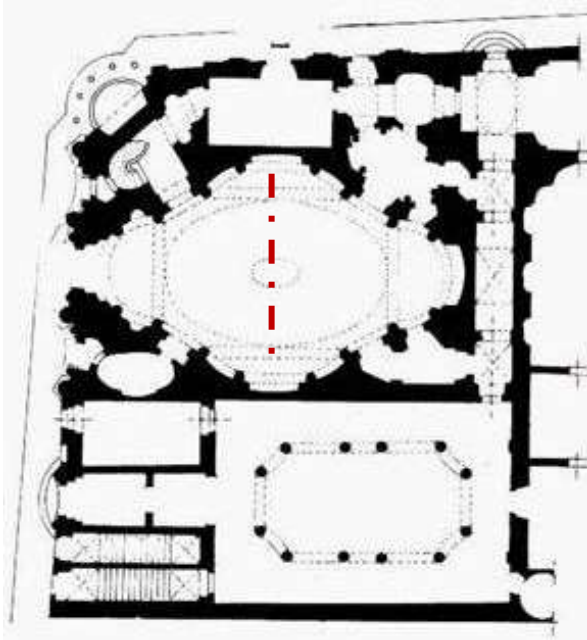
Francesco Borromini, Pianta di San Carlo alle Quattro Fontane a Roma 1638-41
